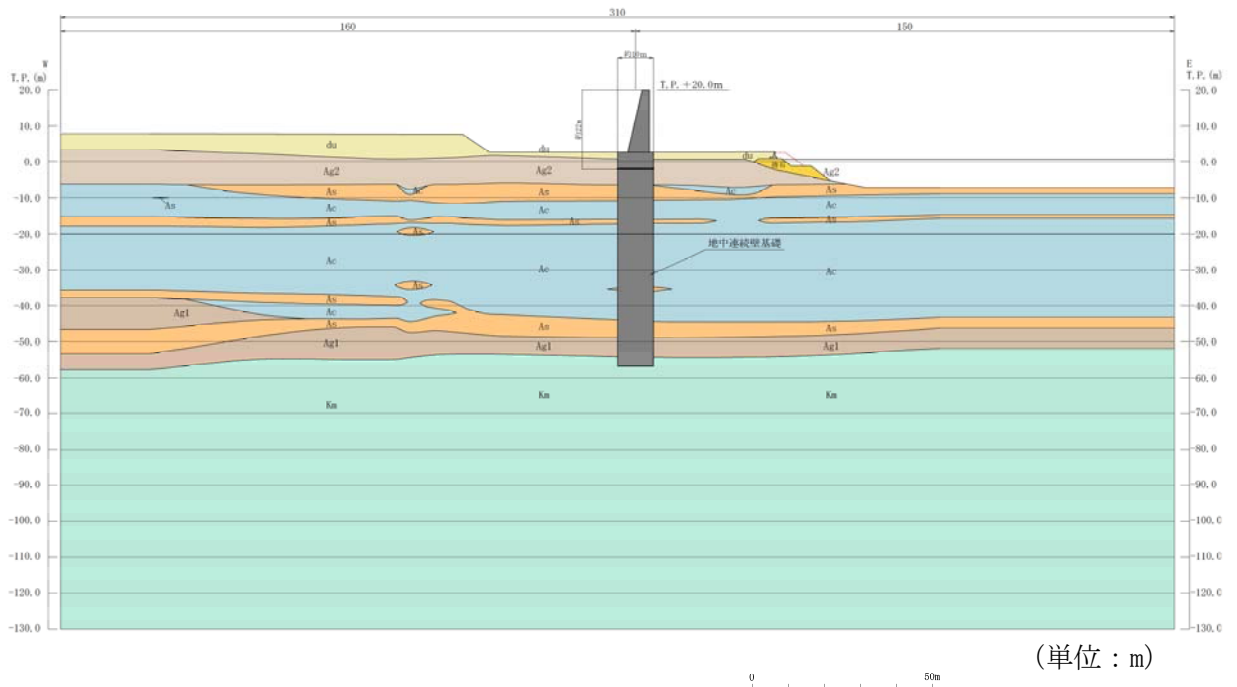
(6) 鉄筋コンクリート防潮壁 断面図(F-F断面)
